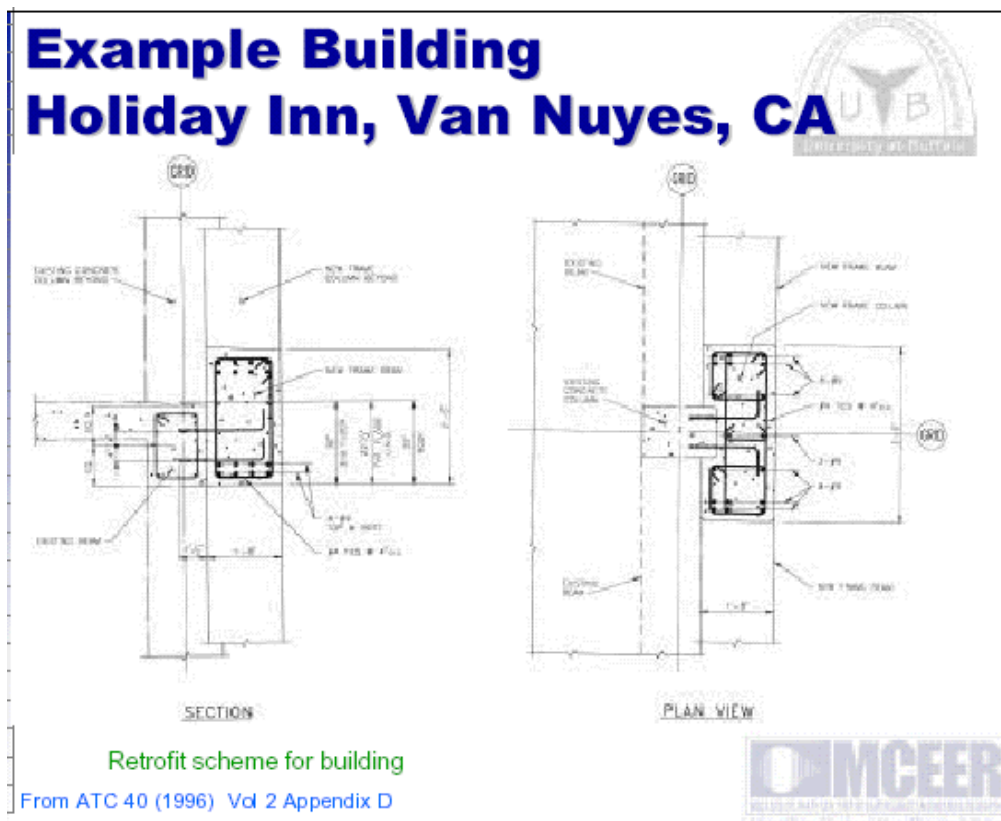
Planos de detalle del mejoramiento sistemático vista en planta y sección.
